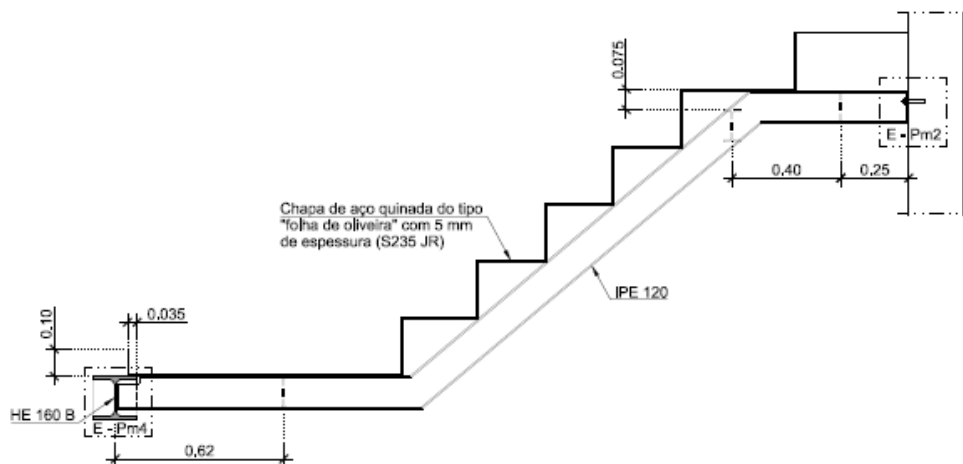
Pormenor estrutural de um lanço de escadas (Projeto de Estruturas)
